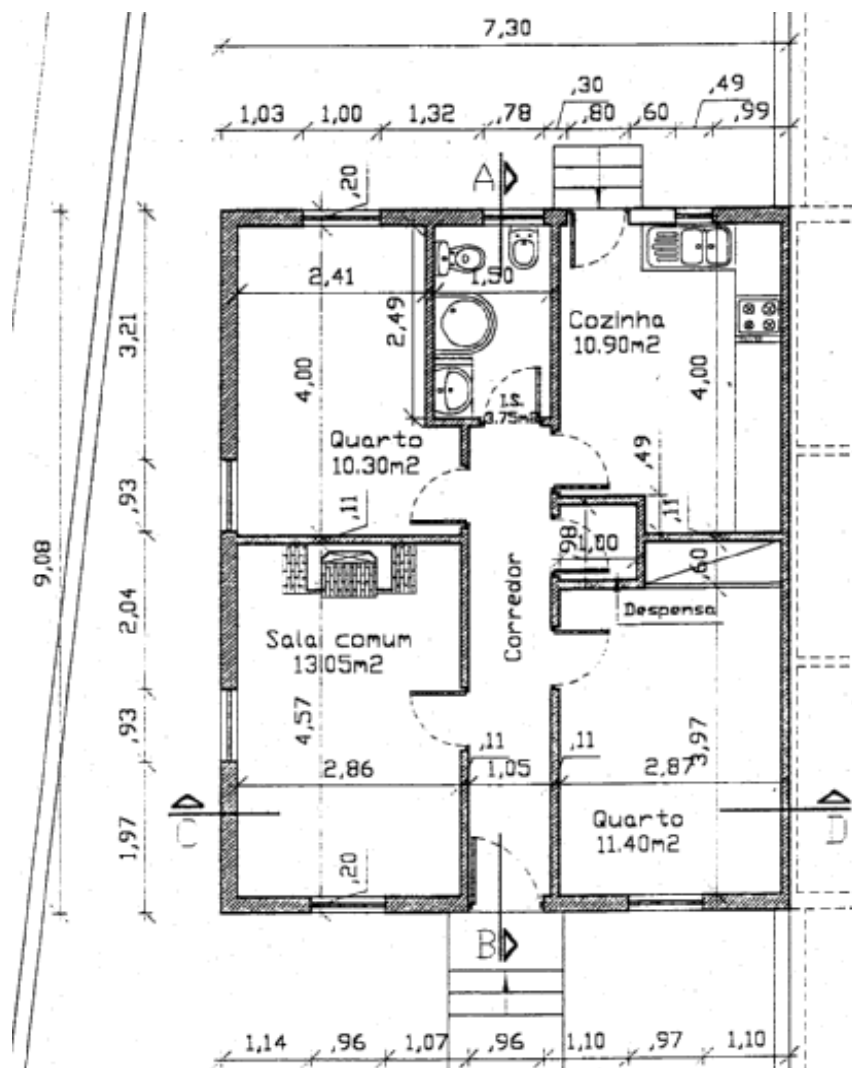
Planta da moradia unifamiliar (fachada principal para baixo).
